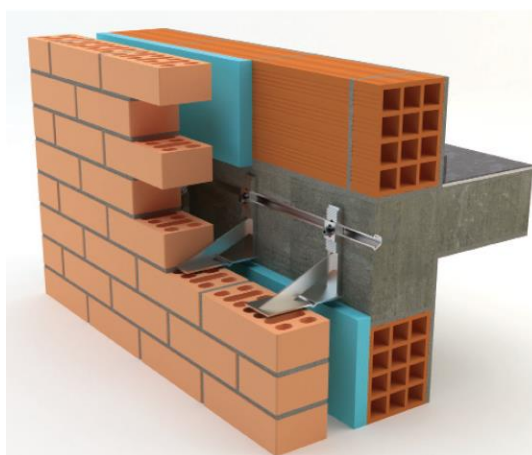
Sistema de fixação a meio da fachada [43]
